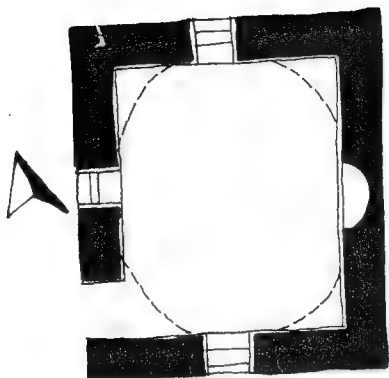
ضريح الحاج ابو بكر بن مبارز - مسقط الفلى
